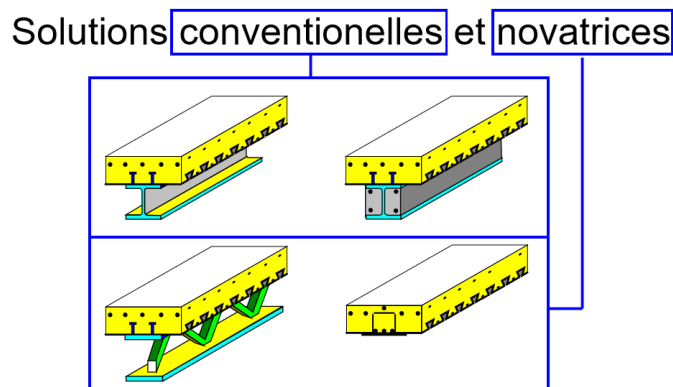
Exemple de poutres mixtes empêchées de déverser [13].
